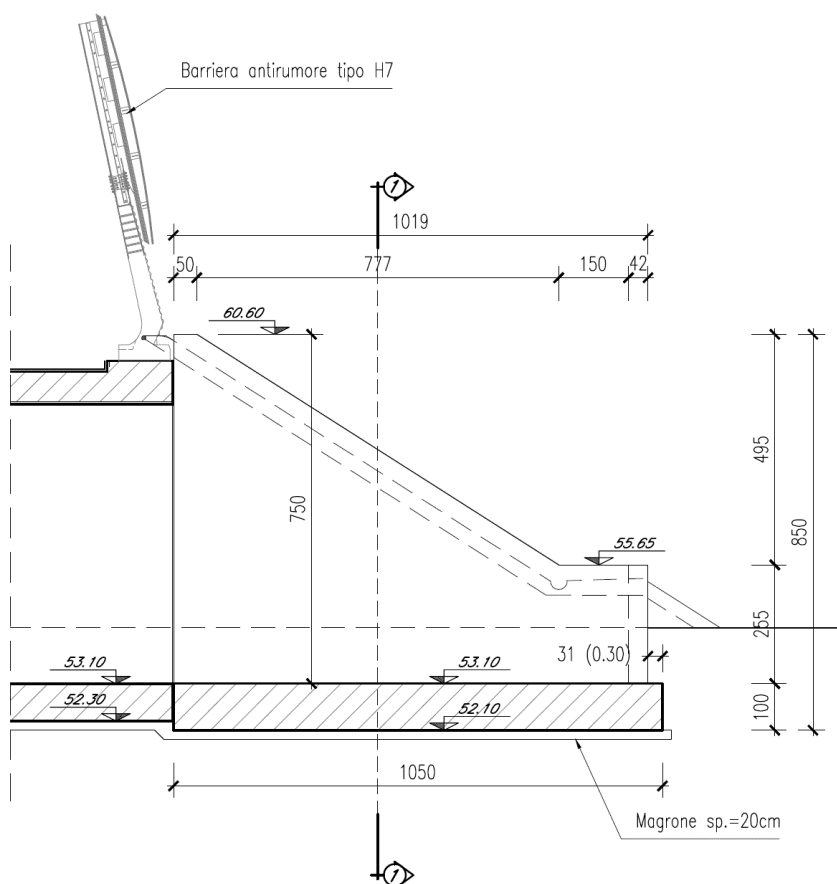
Prospetto Muro B- Sezioni di calcolo 1-1
